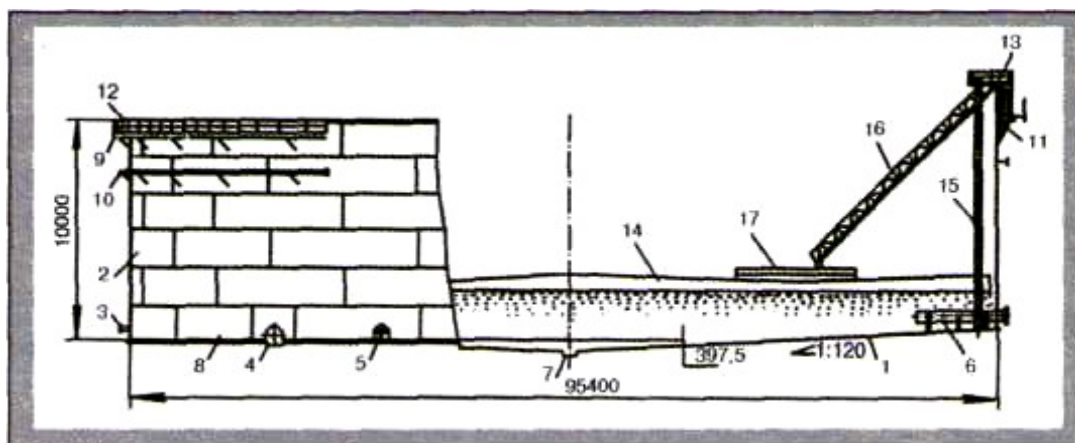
Вертикальный сварной резервуар емкостью 100000 м³ с двухдечной плавающей крышей: 1 – днище; 2 – стенка; 3 – патрубок; 4 – зачистной люк; 5 – люк-лаз; 6 – рассекатель; 7 – зумф; 8 – бобышка заземления; 9 – верхнее ветровое кольцо; 10 – промежуточное кольцо; 11 – лестница; 12 – ограждение; 13 – выход на катучую лестницу; 14 – плавающая крыша; 15 – направляющая; 16 – катучая лестница; 17 – опорная ферма
